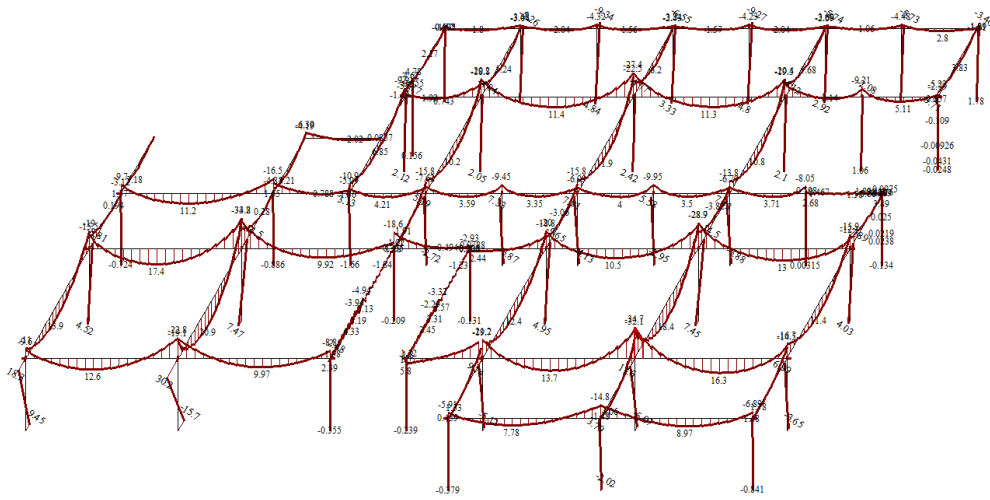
Усилия  $M_y$  в балках перекрытия
